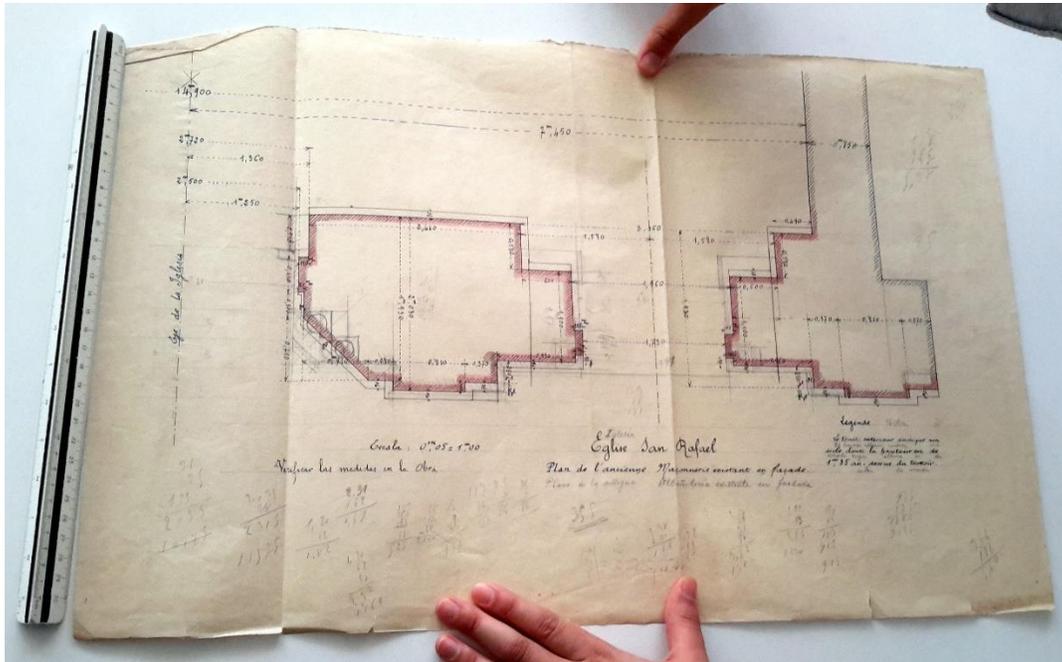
Plano de levantamiento de muros de albañilería “existentes en la fachada” escala 0,05=1 en Parroquia San Rafael, con notas en tinta en francés y traducciones a lápiz de carbón al español, realizadas por E. Joannon. Sin fecha. Fuente: Archivo Joannon Rivera
